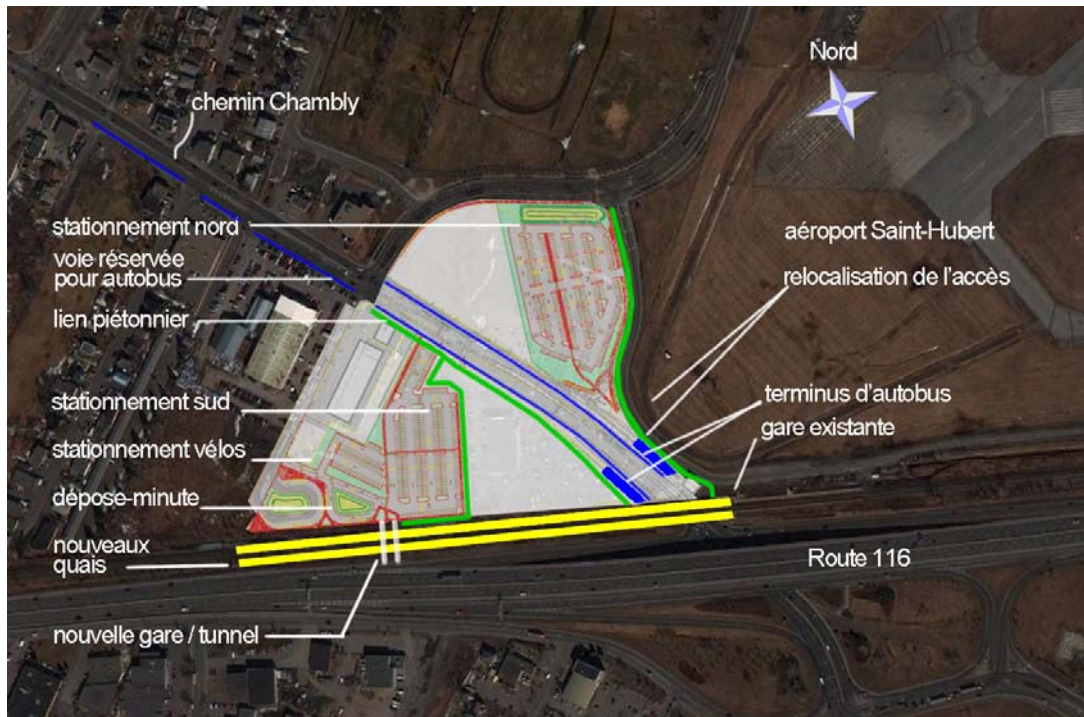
Plan du centre intermodal (Sources : Google Earth et AMT, 2011)
